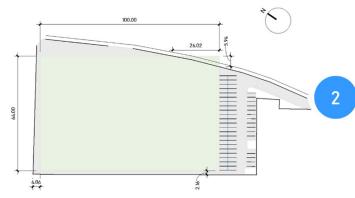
Planta de Indicios de Distribución, Fuente: Elaboración Propia
